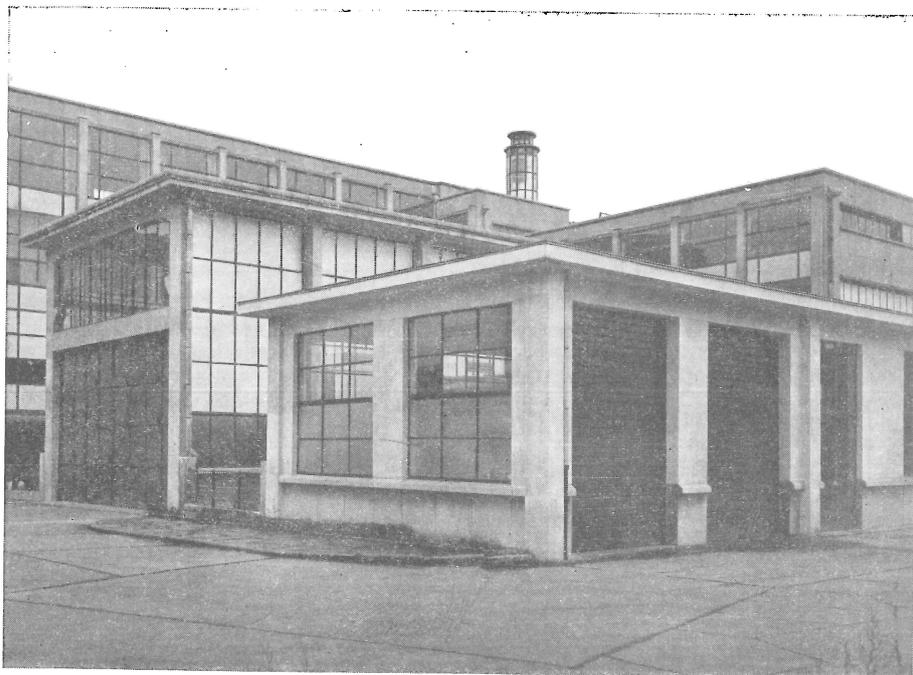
Halle expérimentale et pavillon de soudure
